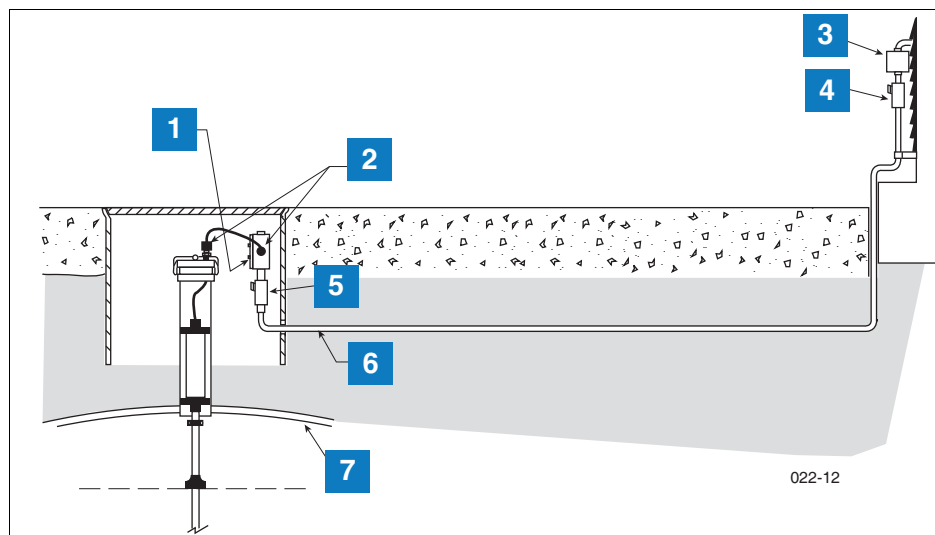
Exemplo de cabeamento de sonda em conduíte rígido enterrado
